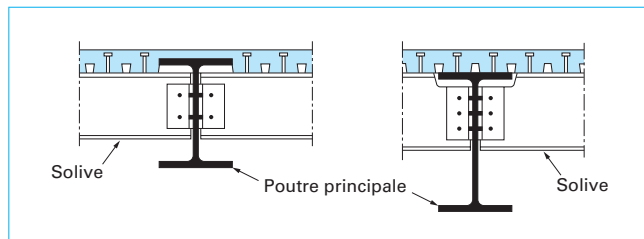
Assemblages de type poutre-poutre de plancher mixte
